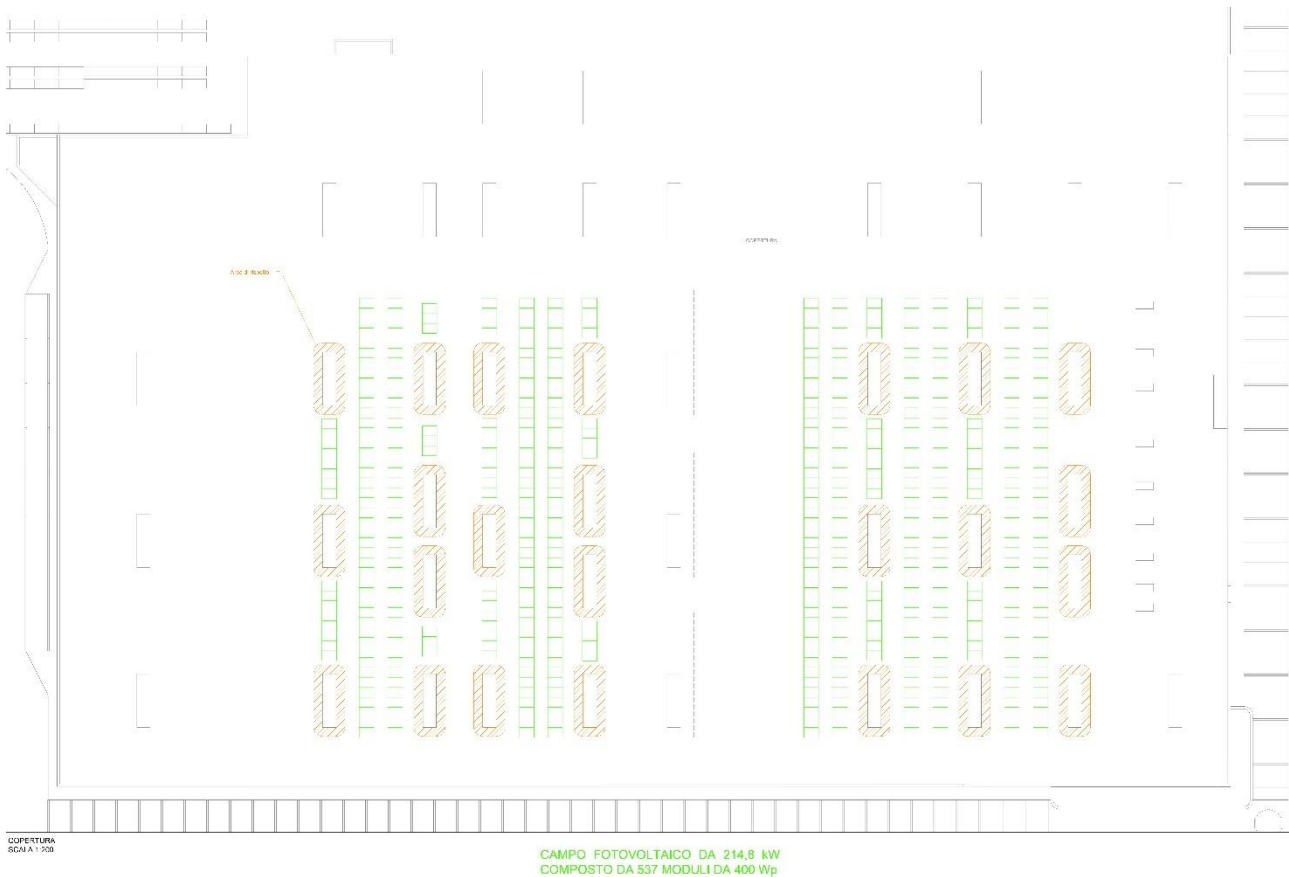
Rappresentazione planimetrica del campo fotovoltaico (Fonte: Planimetria distribuzione impianto fotovoltaico – AI Progetti)
